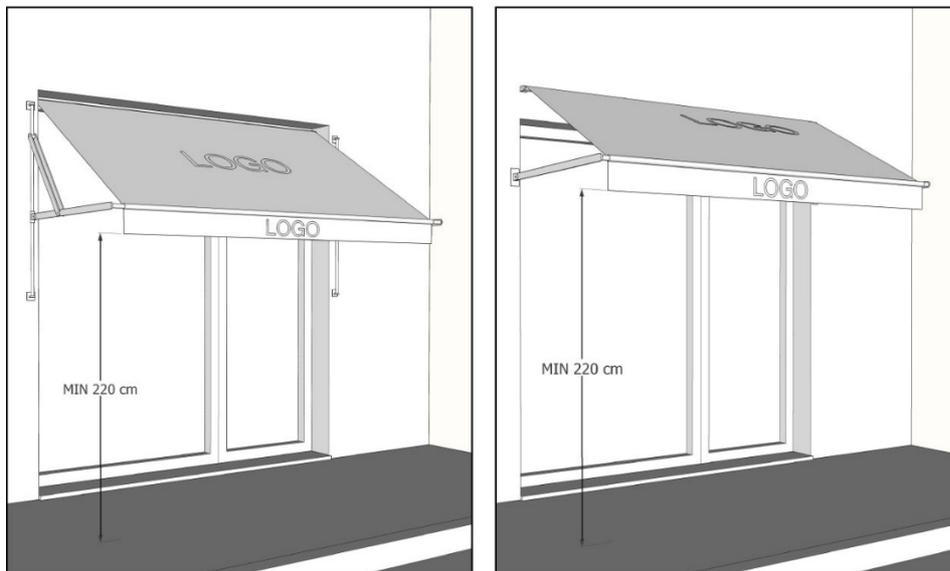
Schema installazione tenda ed esempi tenda a caduta conbracci a sbalzo
